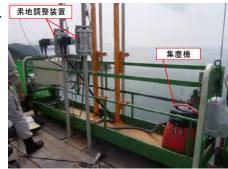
素地調整装置コントラ取付状況 (Photo.2 Installation at a gondola)
